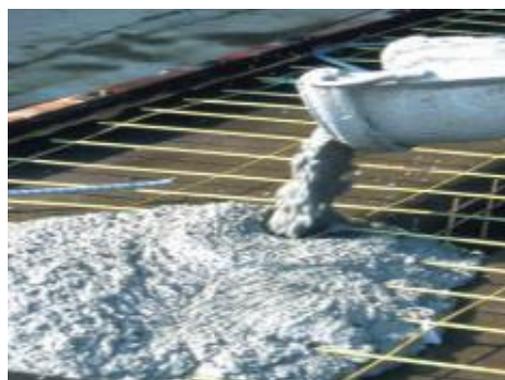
Execução de pavimento com betão branco (BASF, 2021)
